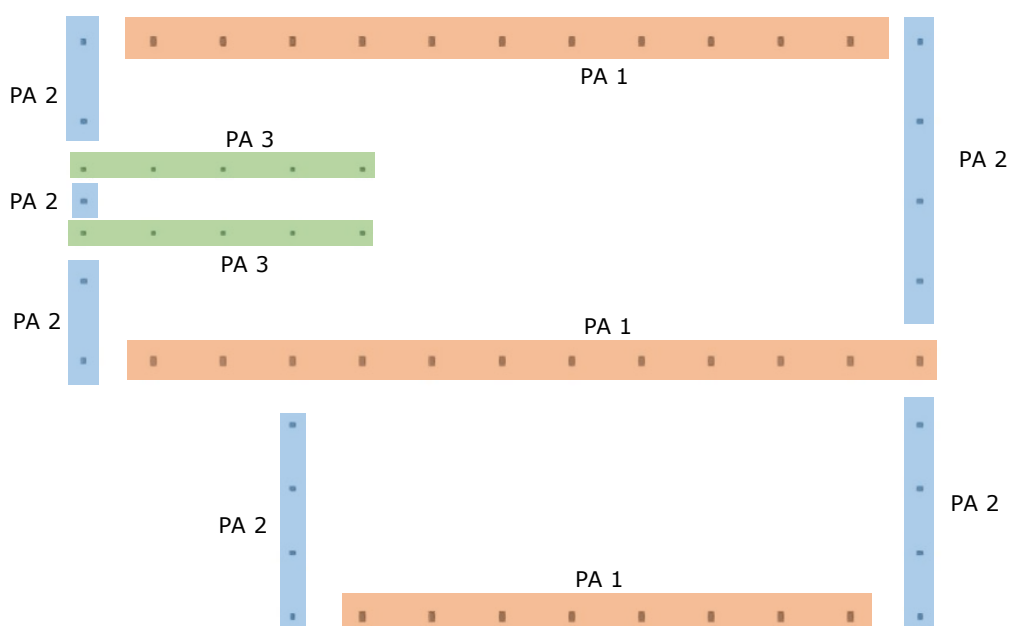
M. Tipos de placas de anclaje de la estructura.
